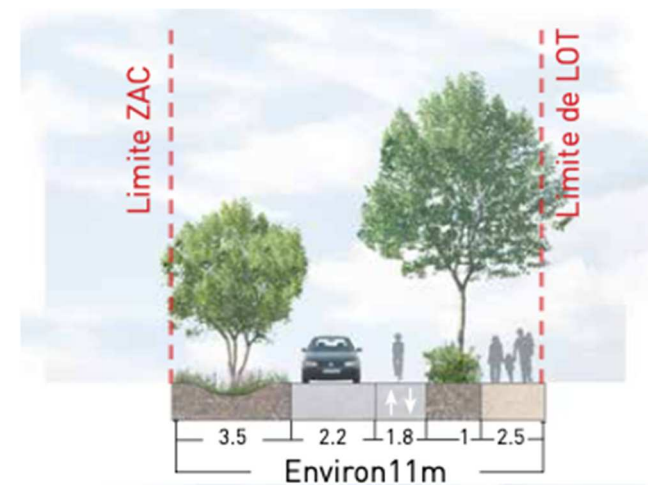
Coupe DD' sur la voie nouvelle (Ville de Roanne)
